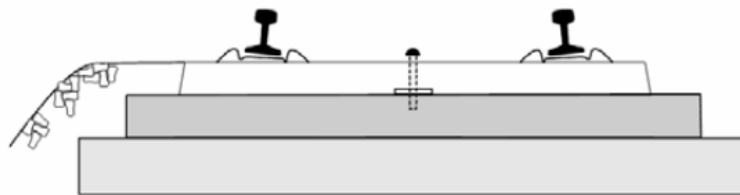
Esquema del sistema de traviesas apoyadas sobre losa BTB. Fuente: <http://www.ciccp.es>
